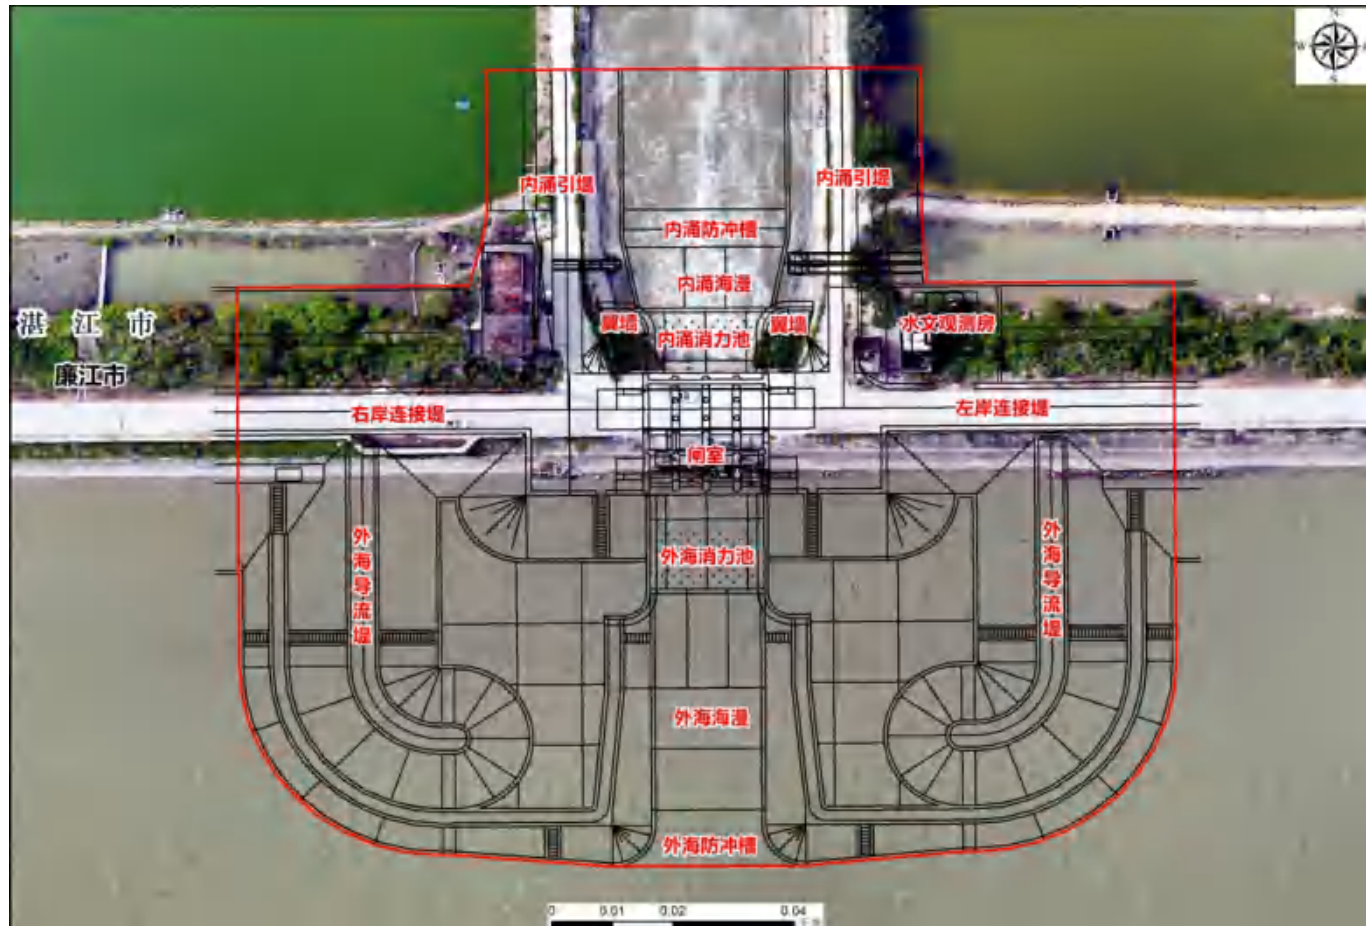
项目总平面布置用海示意图（主体工程）
